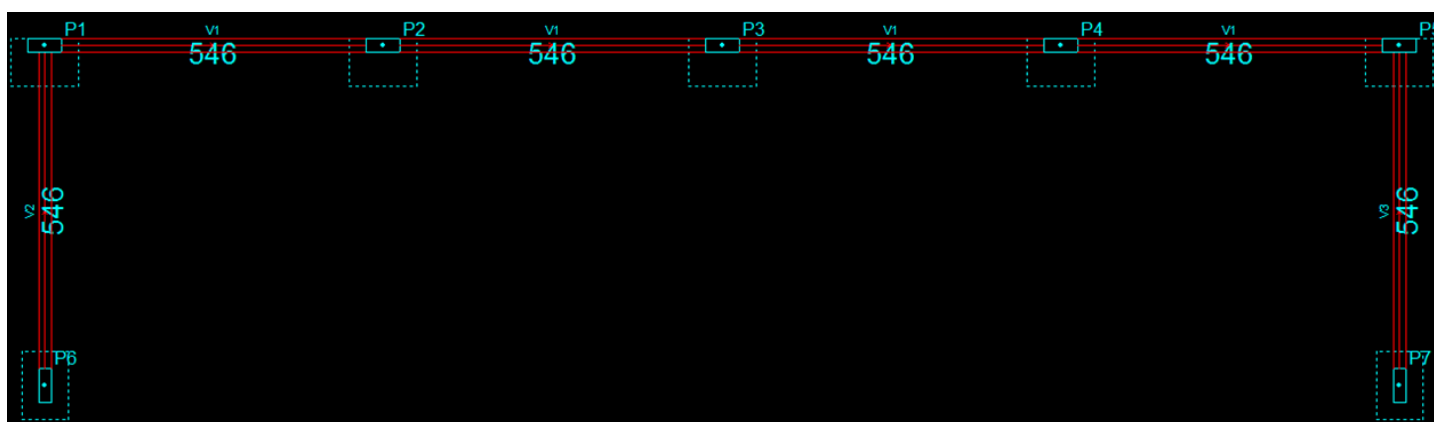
Lançamento da estrutura no pavimento “Térreo”
